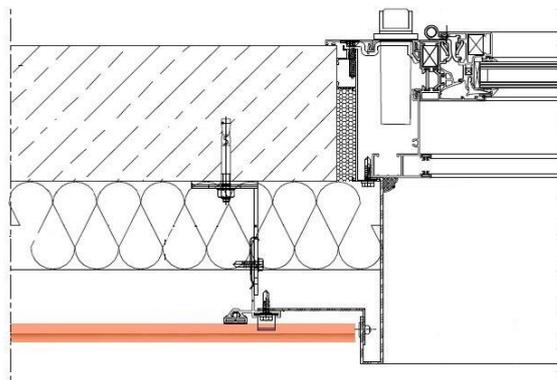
Jamba con pieza metálica. FAVEKER® FV. Sistema clip.
